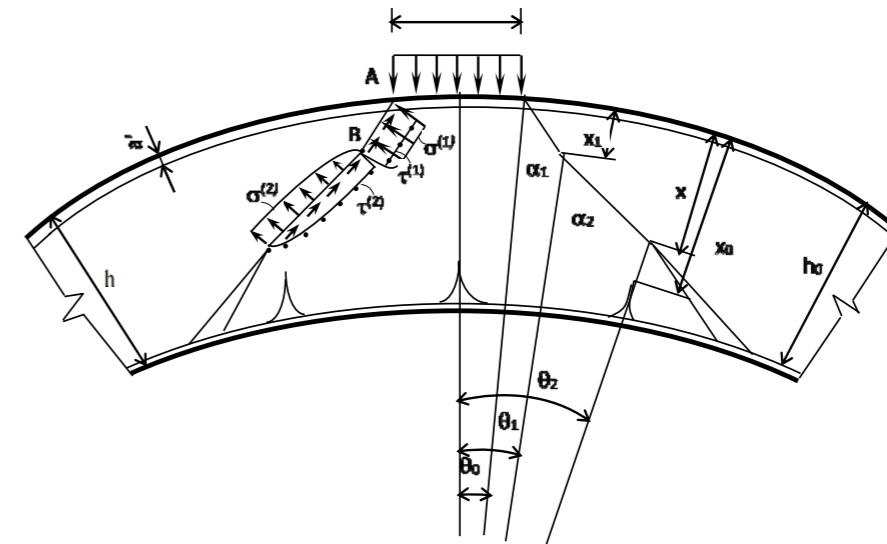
Расчетная схема железобетонных оболочек при действии локальных нагрузок
